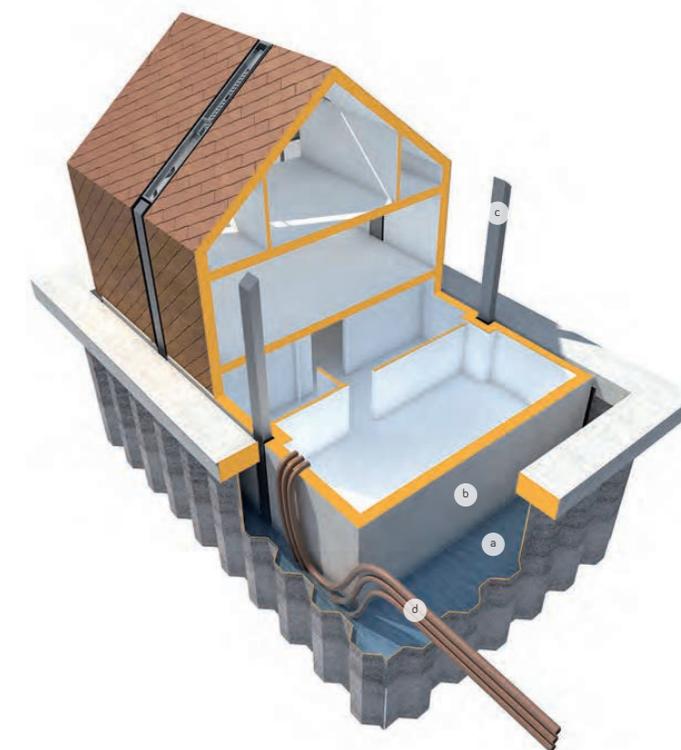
Sezione assonometrica: componenti del sistema di galleggiamento
